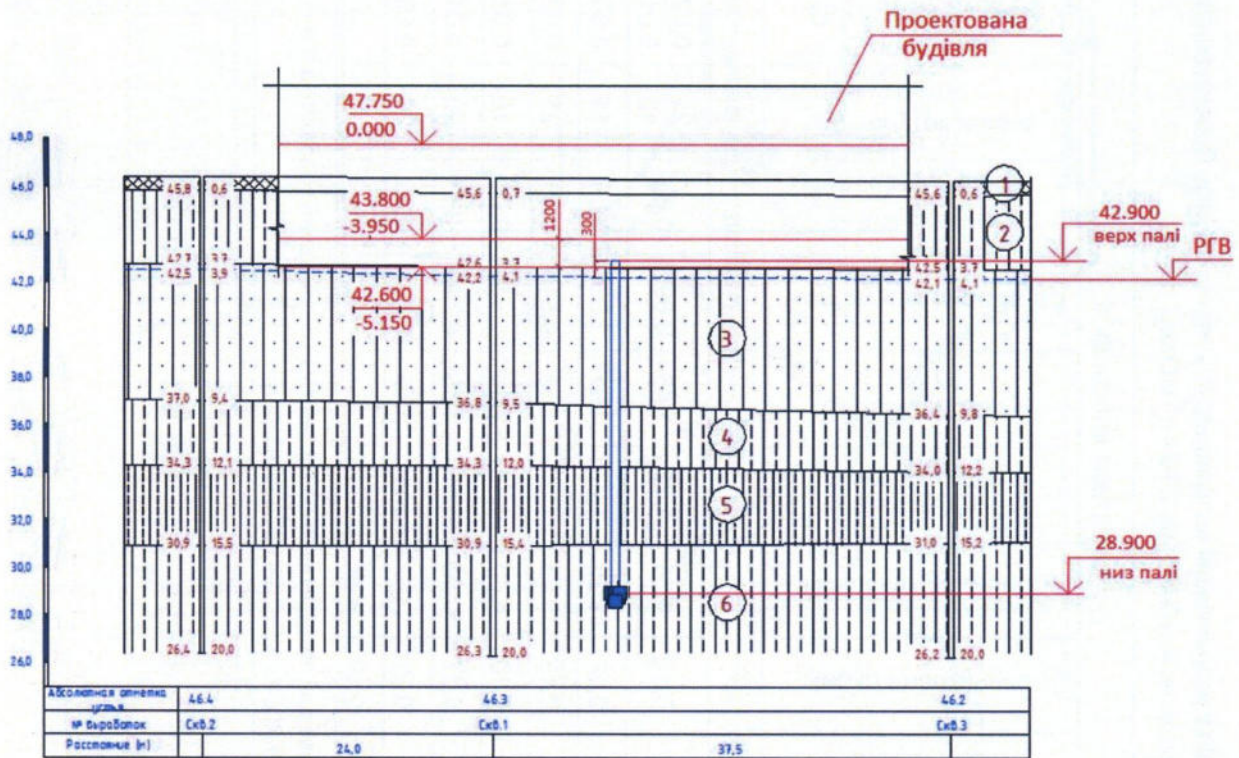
Посадка будівлі на інженерно-геологічний розріз
